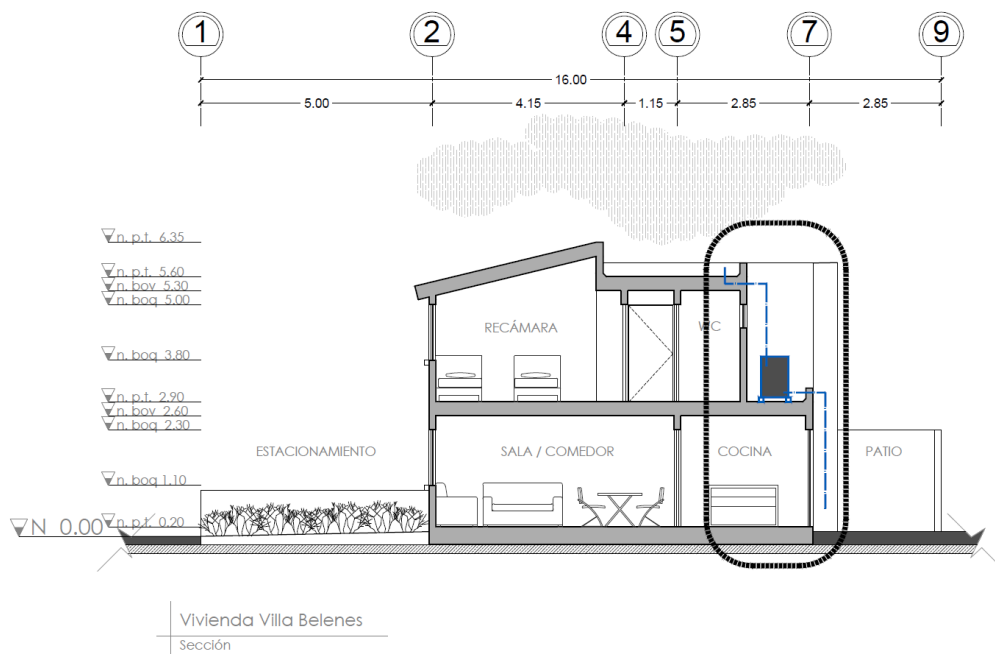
Esquema en sección de la idea planteada por Carlos F. Muñoz para aprovechamiento pluvial. Fuente: Elaboración propia en software Autocad.
